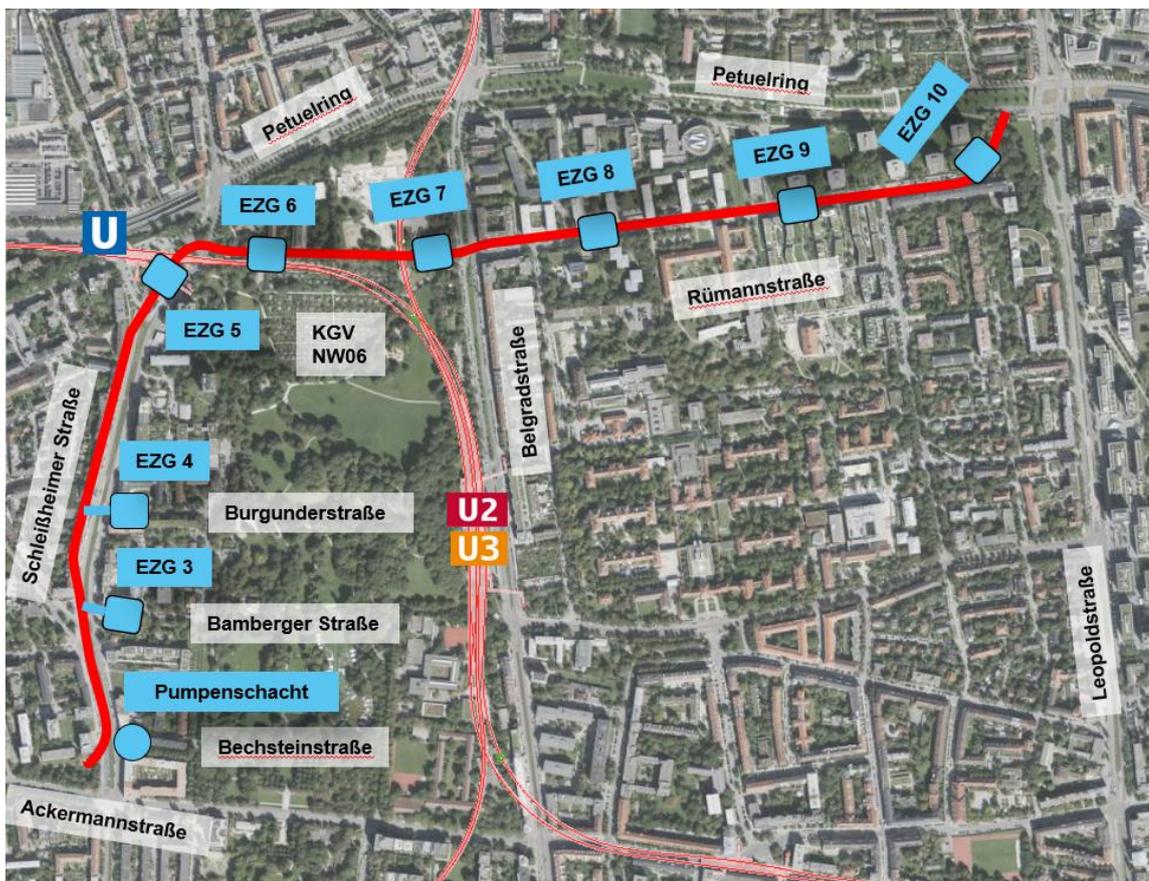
Standorte Baugruben Sanierungsabschnitt Ost - Schleißheimer Straße / Rümmanstraße
